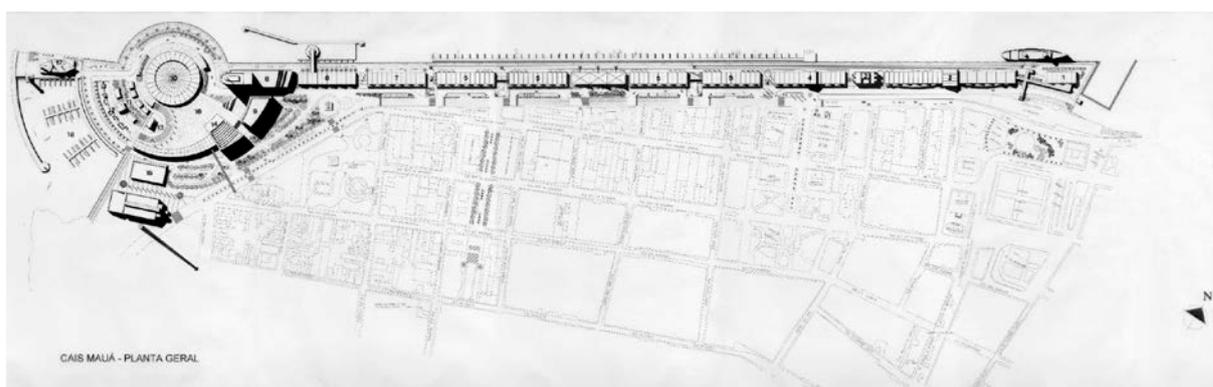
Planta Geral da proposta de intervenção do projeto vencedor do Concurso Porto dos Casais para a área do Cais Mauá.
